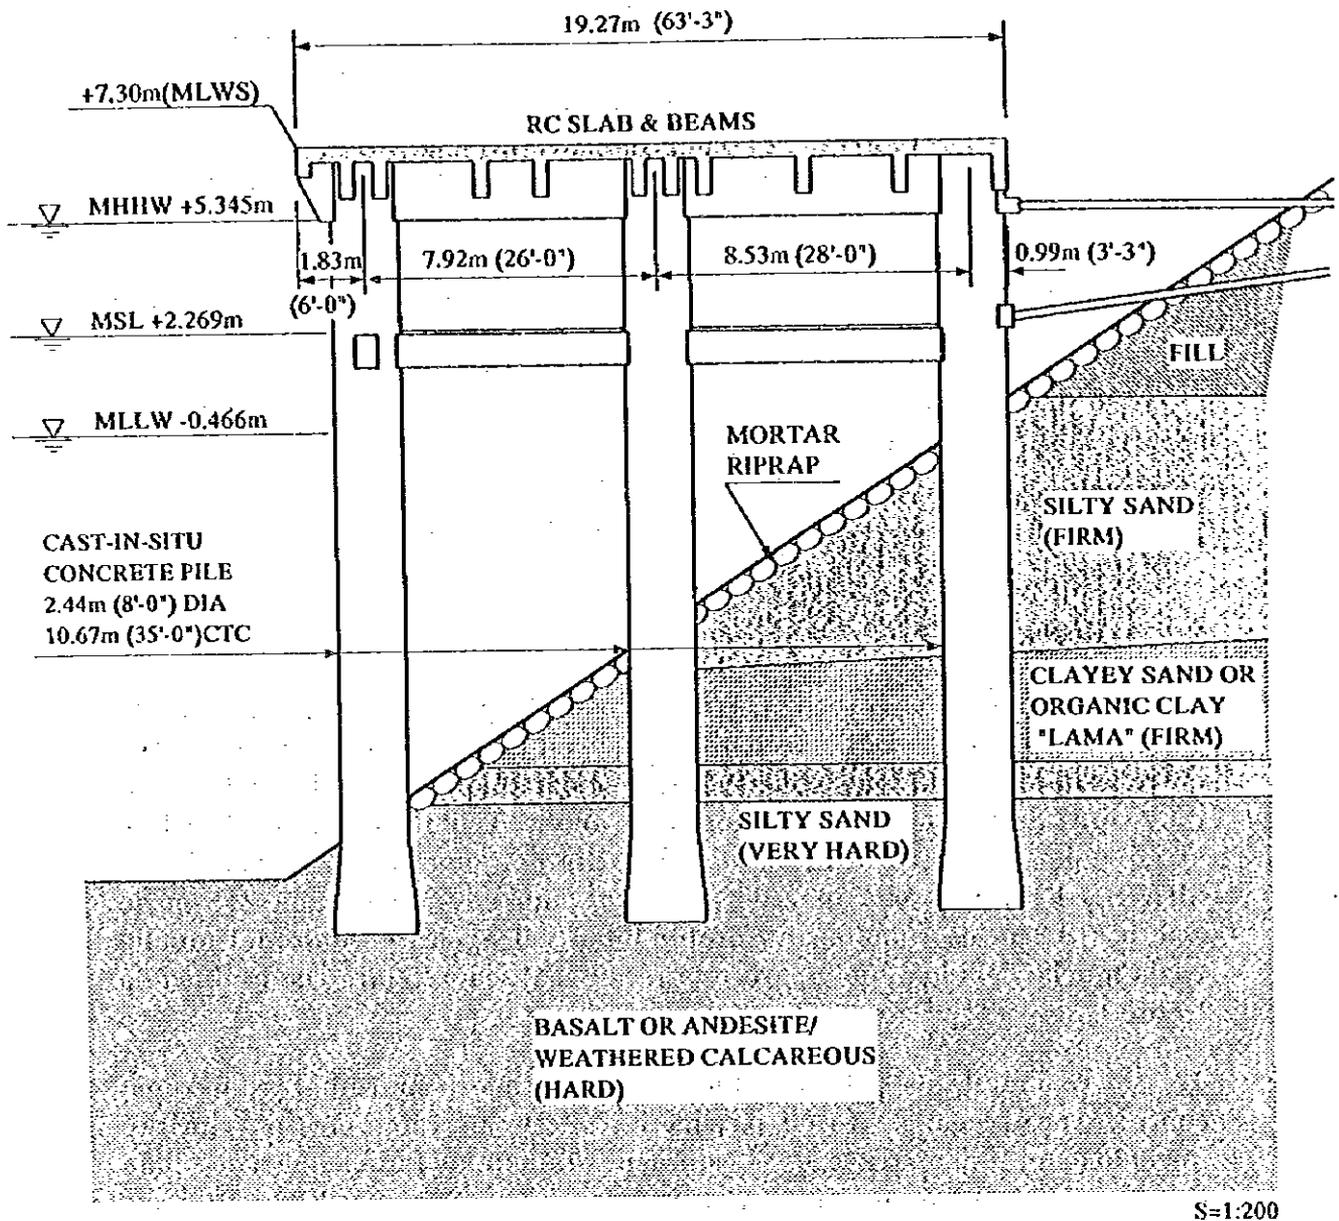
Sección Transversal Simplificada del Muelle N° 6
